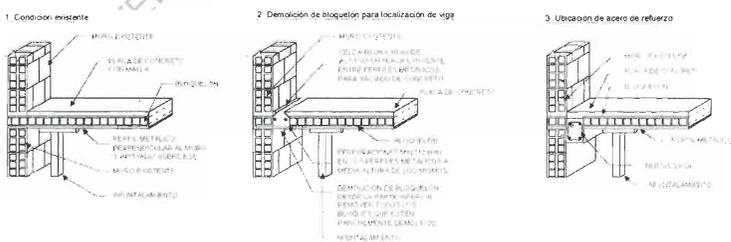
Construcción de nueva viga para dar rigidez al diafragma. Viga paralela a los perfiles metálicos.
